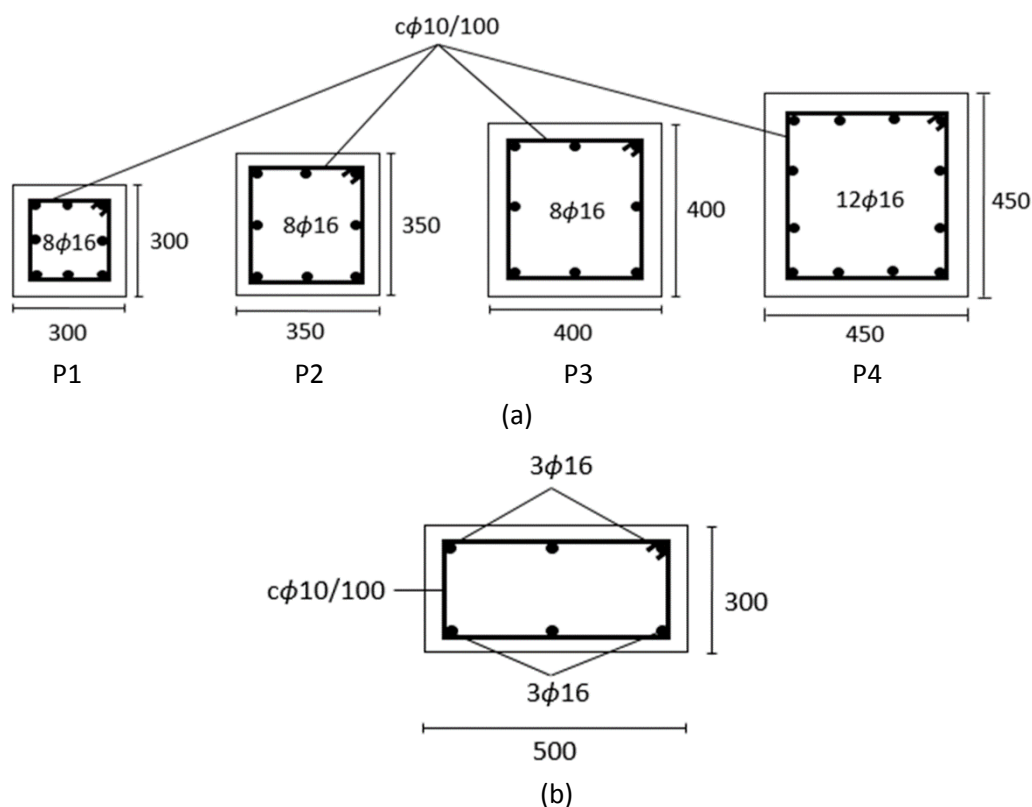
Secciones transversales del pórtico de 8 plantas. (a) Pilares. (b) Vigas.
